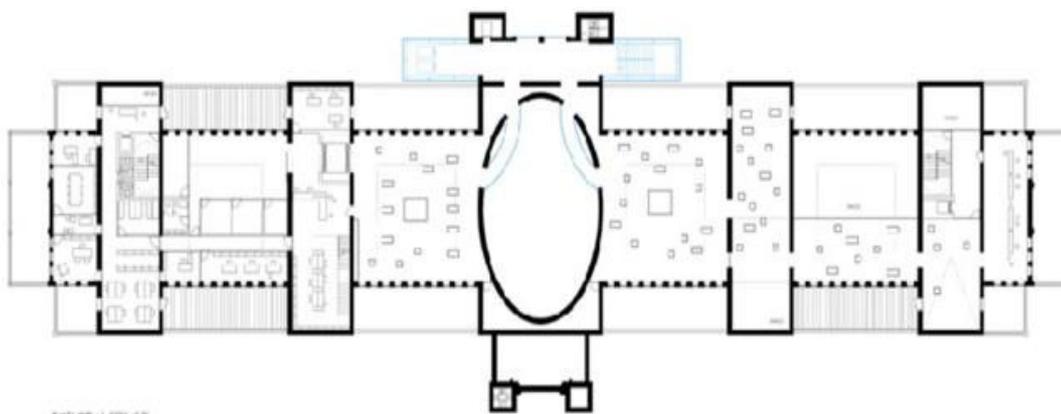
Plano de la nueva ampliación, planta nivel +1.
